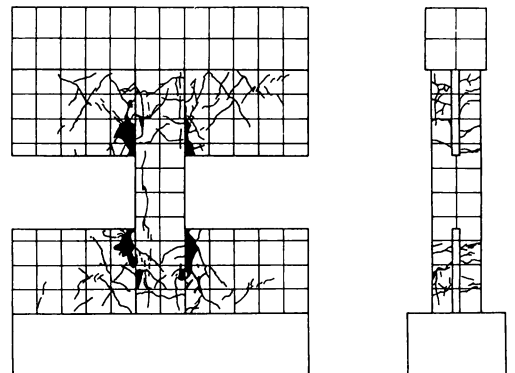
(a) 試験体 CSS01 の実験終了時のひび割れ図
